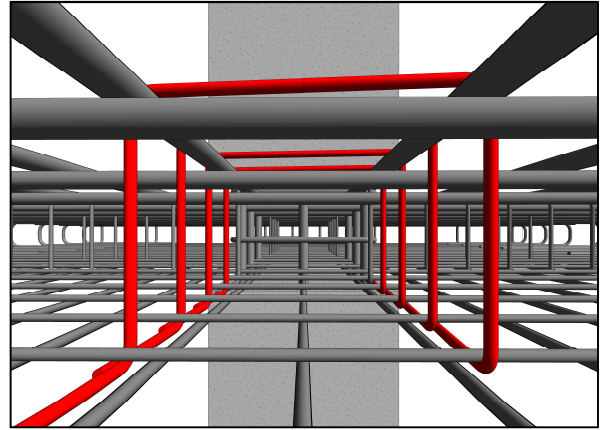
Detalhe do estribo “caranguejo” na laje CFA.
